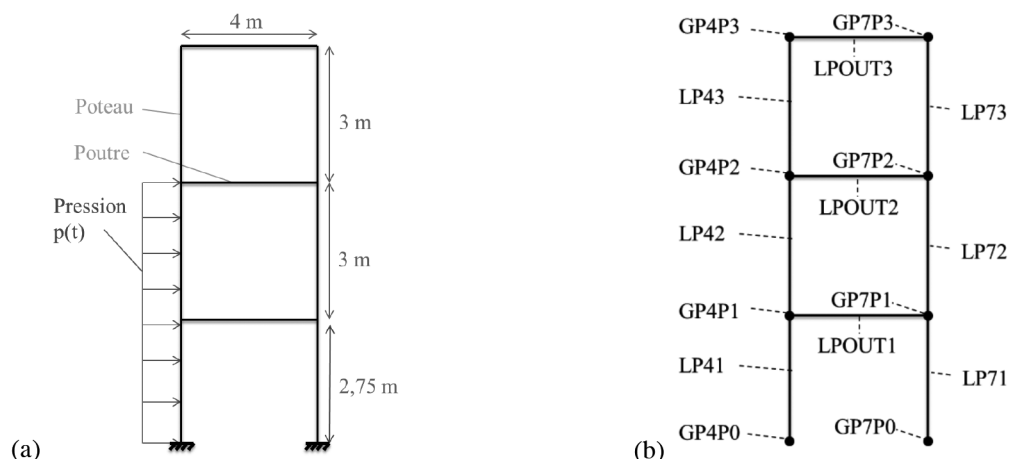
Structure poteaux-poutres considérée : (a) dimensions et (b) modèle numérique [TAT 11]
